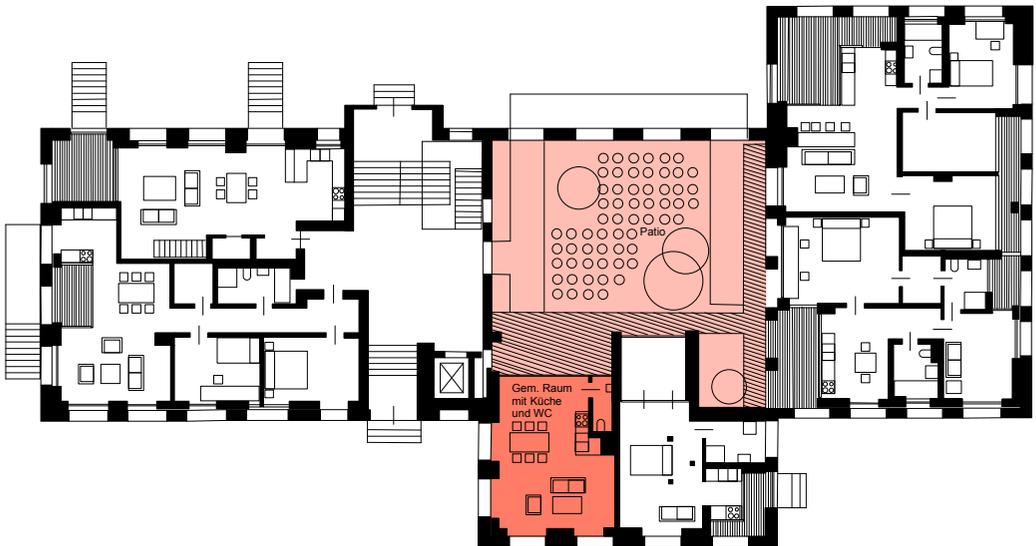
Alte Tabakfabrik, Grundriss EG mit Gemeinschaftsraum und Patiohof
